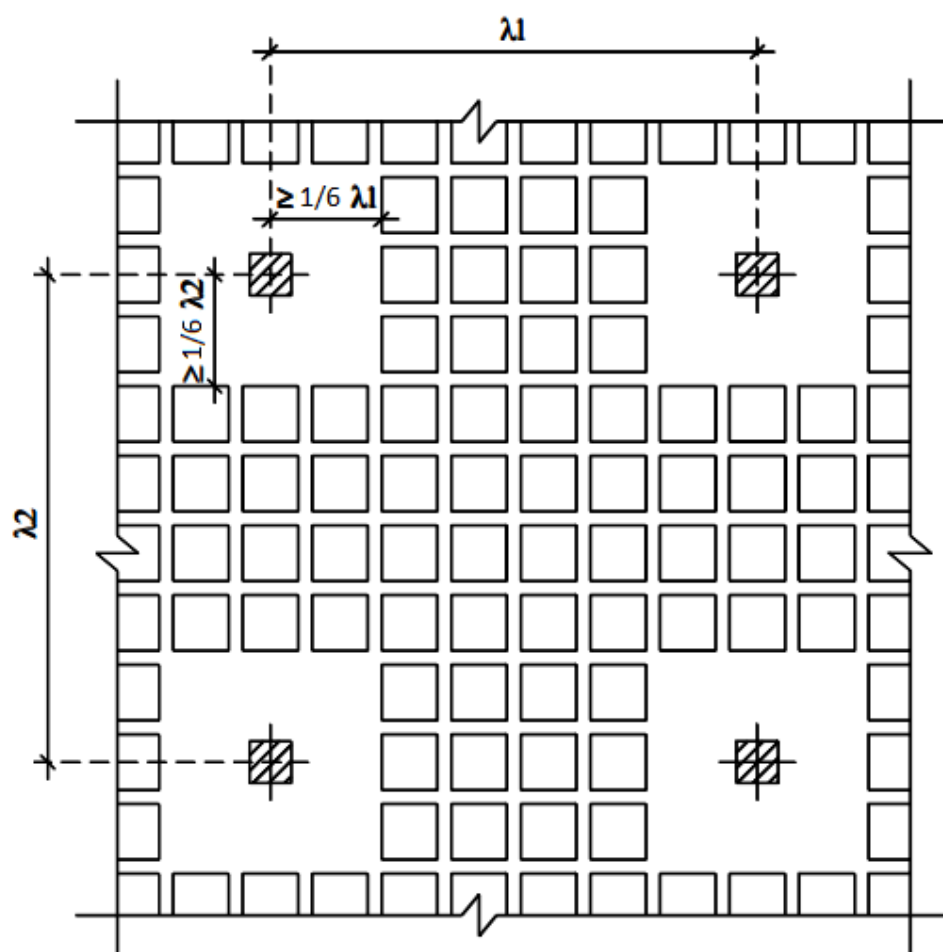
Configuração das dimensões do maciço da laje nervurada lisa (SILVA, 2005).
